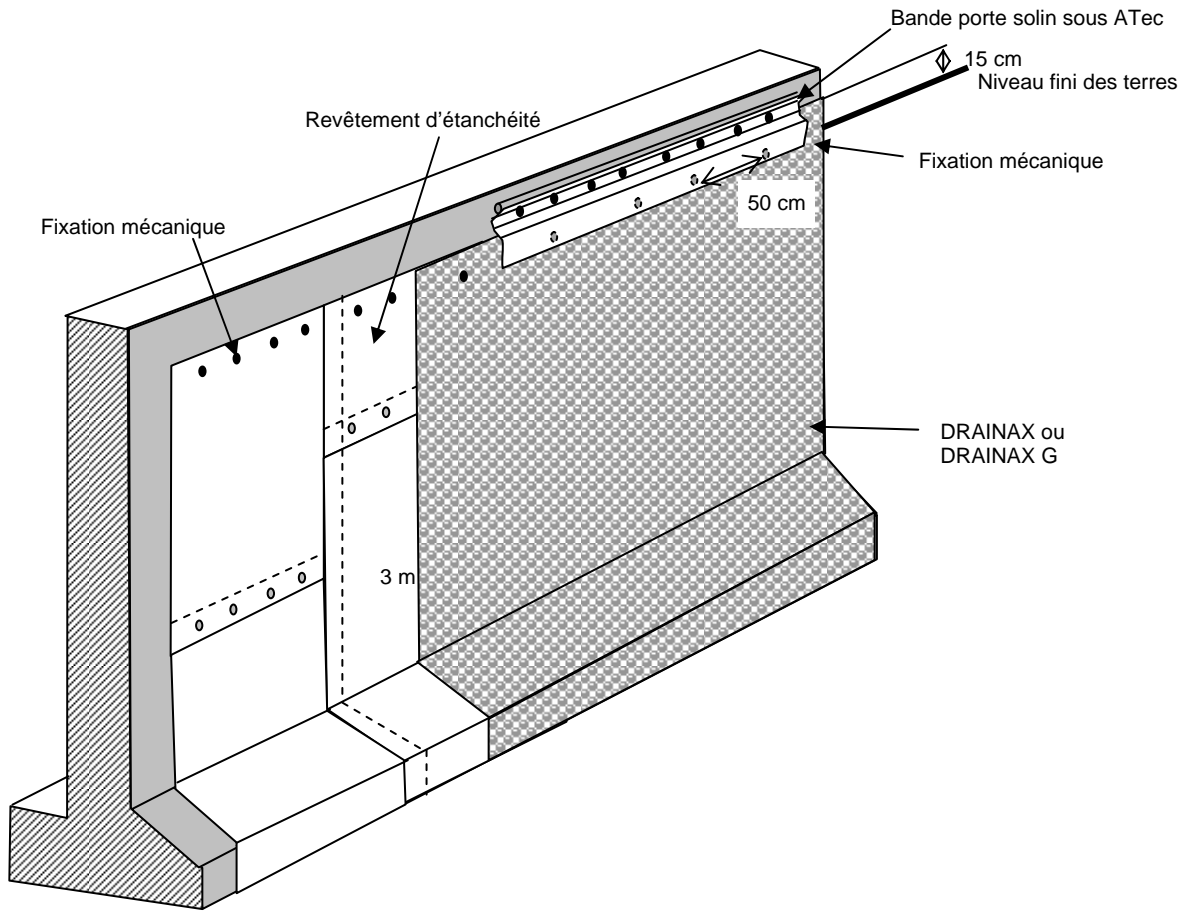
Exemple de mise en œuvre du DRAINAX / DRAINAX G sur revêtement d'étanchéité pour $h < 2$ m
